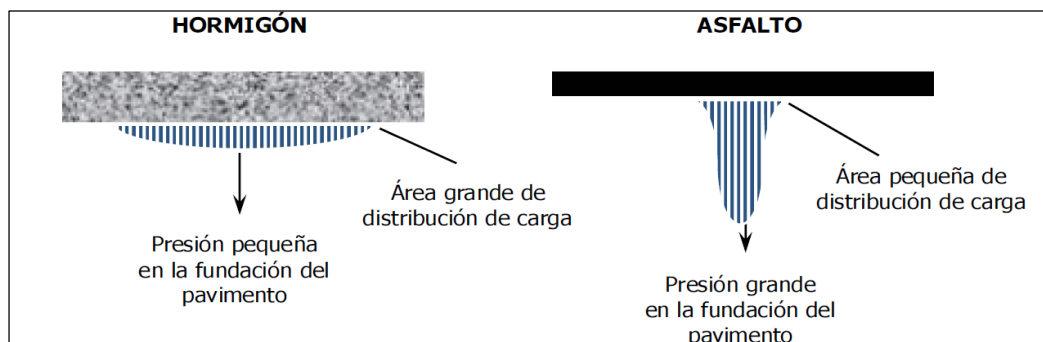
Esquema del comportamiento de pavimentos flexibles y rígidos
